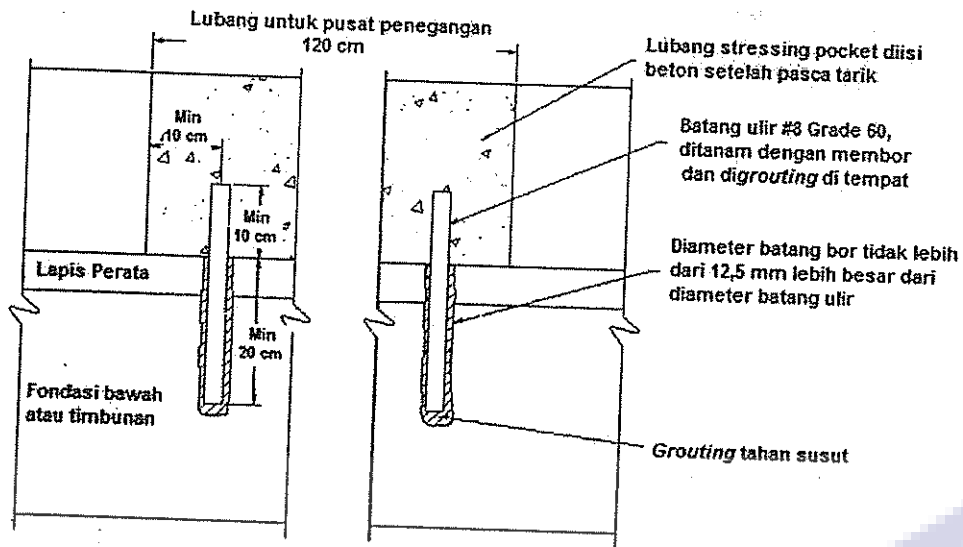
Sambungan peralihan perkerasan beton semen baru dengan perkerasan beton semen lama
